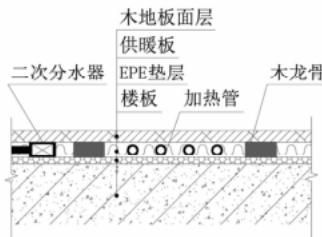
1 预制轻薄供暖板地面构造示意(一)
